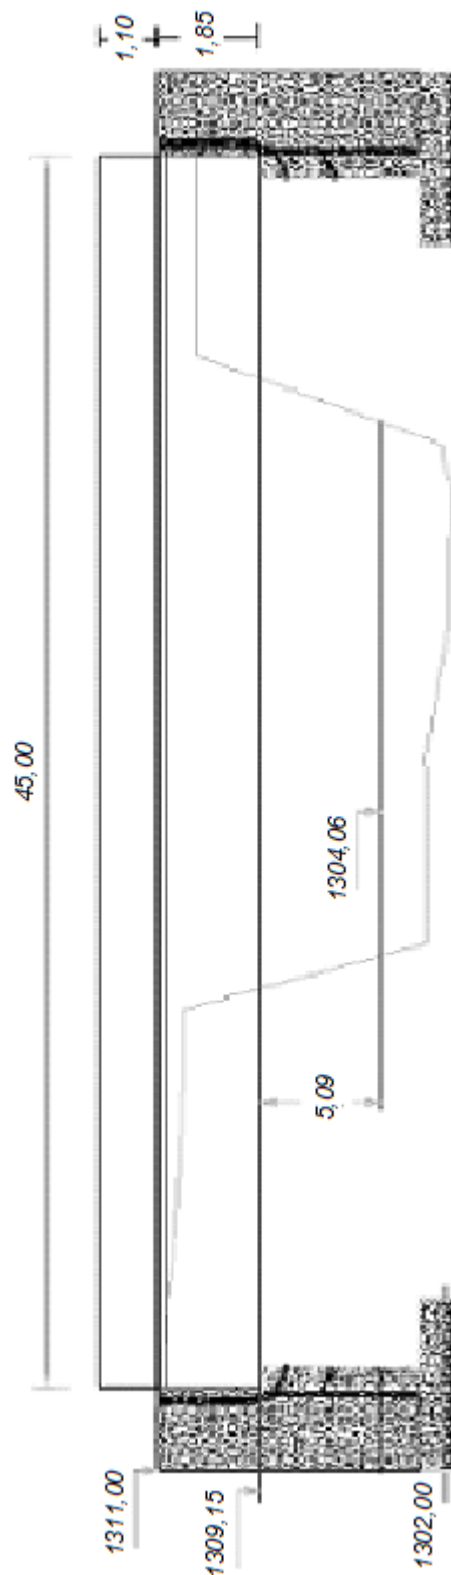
Elevación del puente de sección compuesta de vigas longitudinales simplemente apoyadas de acero y tablero de hormigón armado
